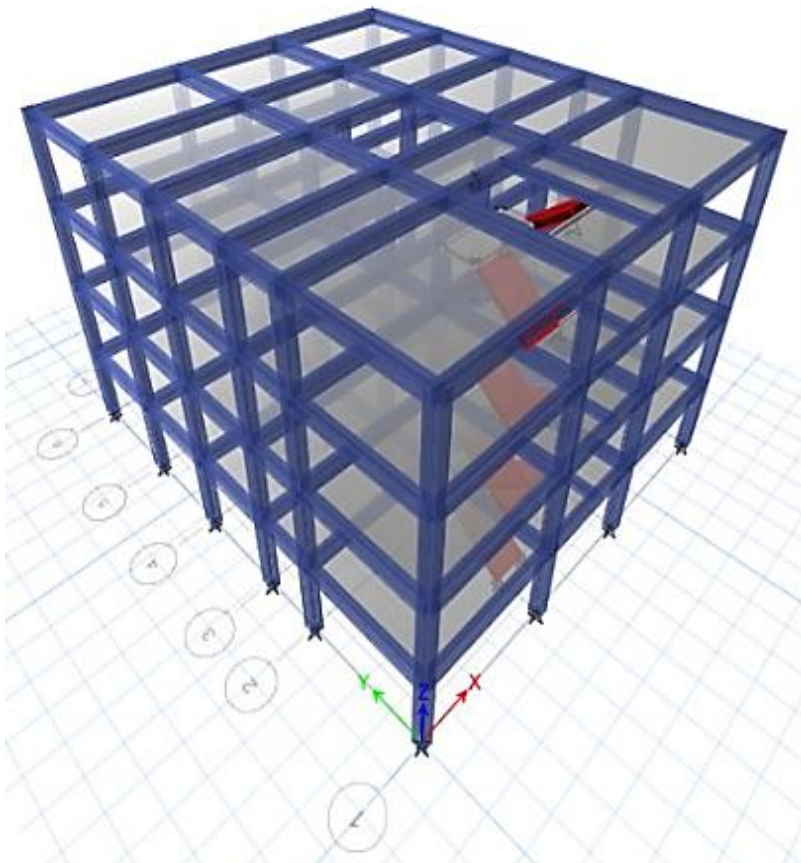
Vista 3D de la vivienda de 4 piso (Etabs)
